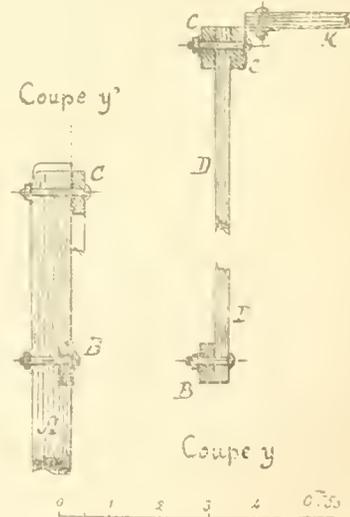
Détail des assemblages de la charpente fig. 4.
